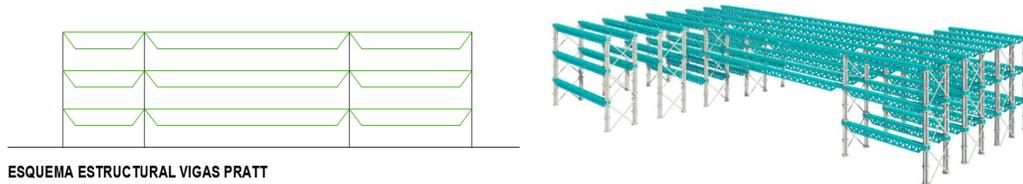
Esquema Vigas Pratt Estructura
